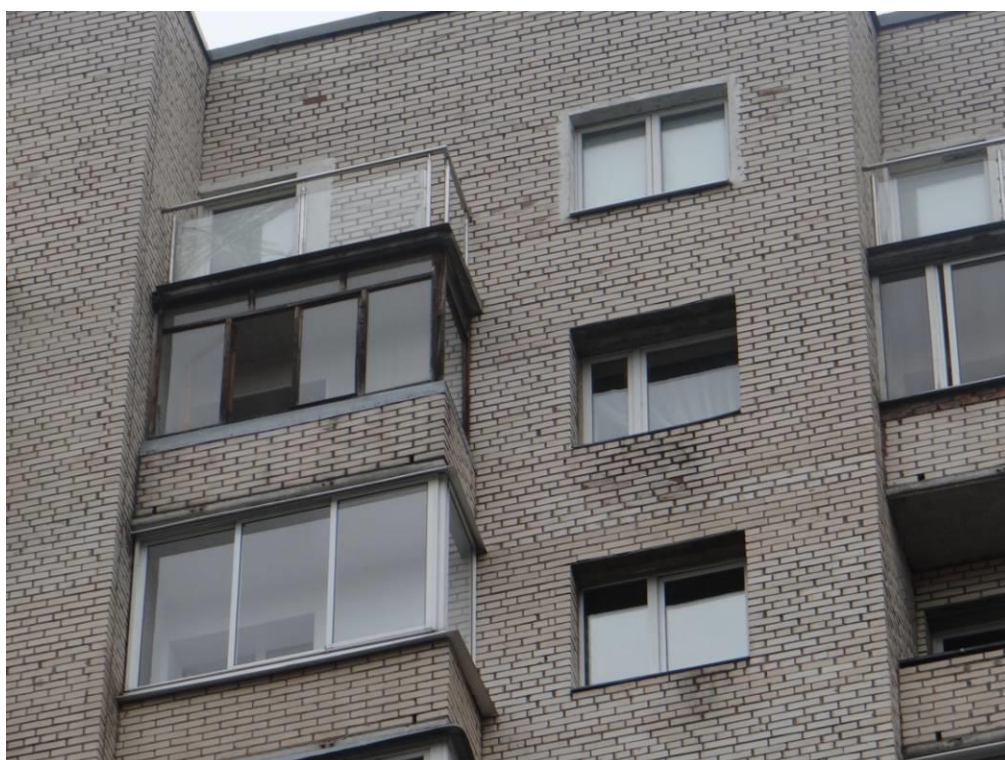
Фрагмент фасада по оси «Д» на участке в осях «8» - «7» в уровне 12 этажа. Следы увлажнения кирпичной кладки под оконным проемом. Морозное разрушение материалов кладки на увлажненных участках.
